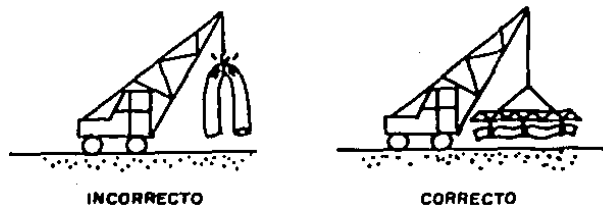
TRANSPORTE DEL GEOTEXTIL
